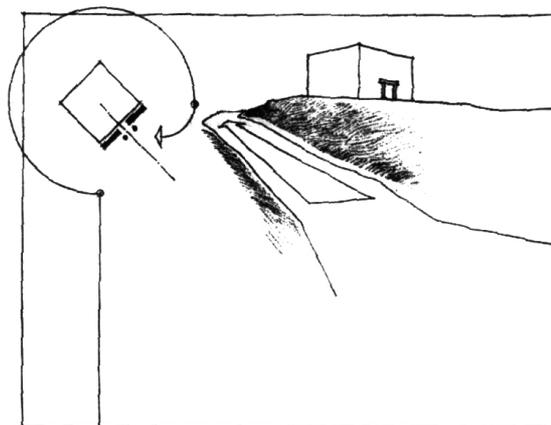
Pencapaian Bangunan secara Tersamar
